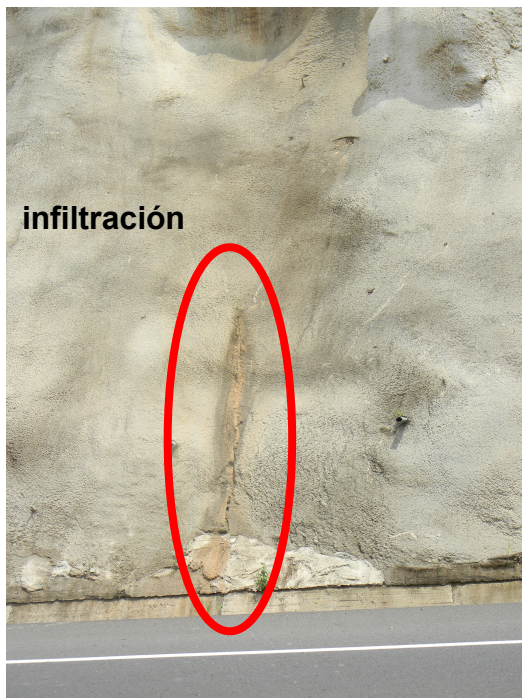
Daños en la cubierta de concreto lanzado, est. 36+000.
